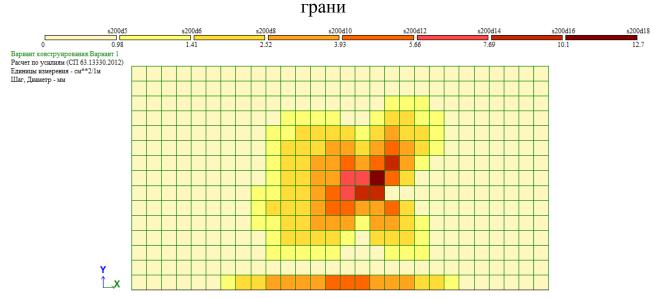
Площадь арматуры на 1 погонный метр по оси У у нижней грани
